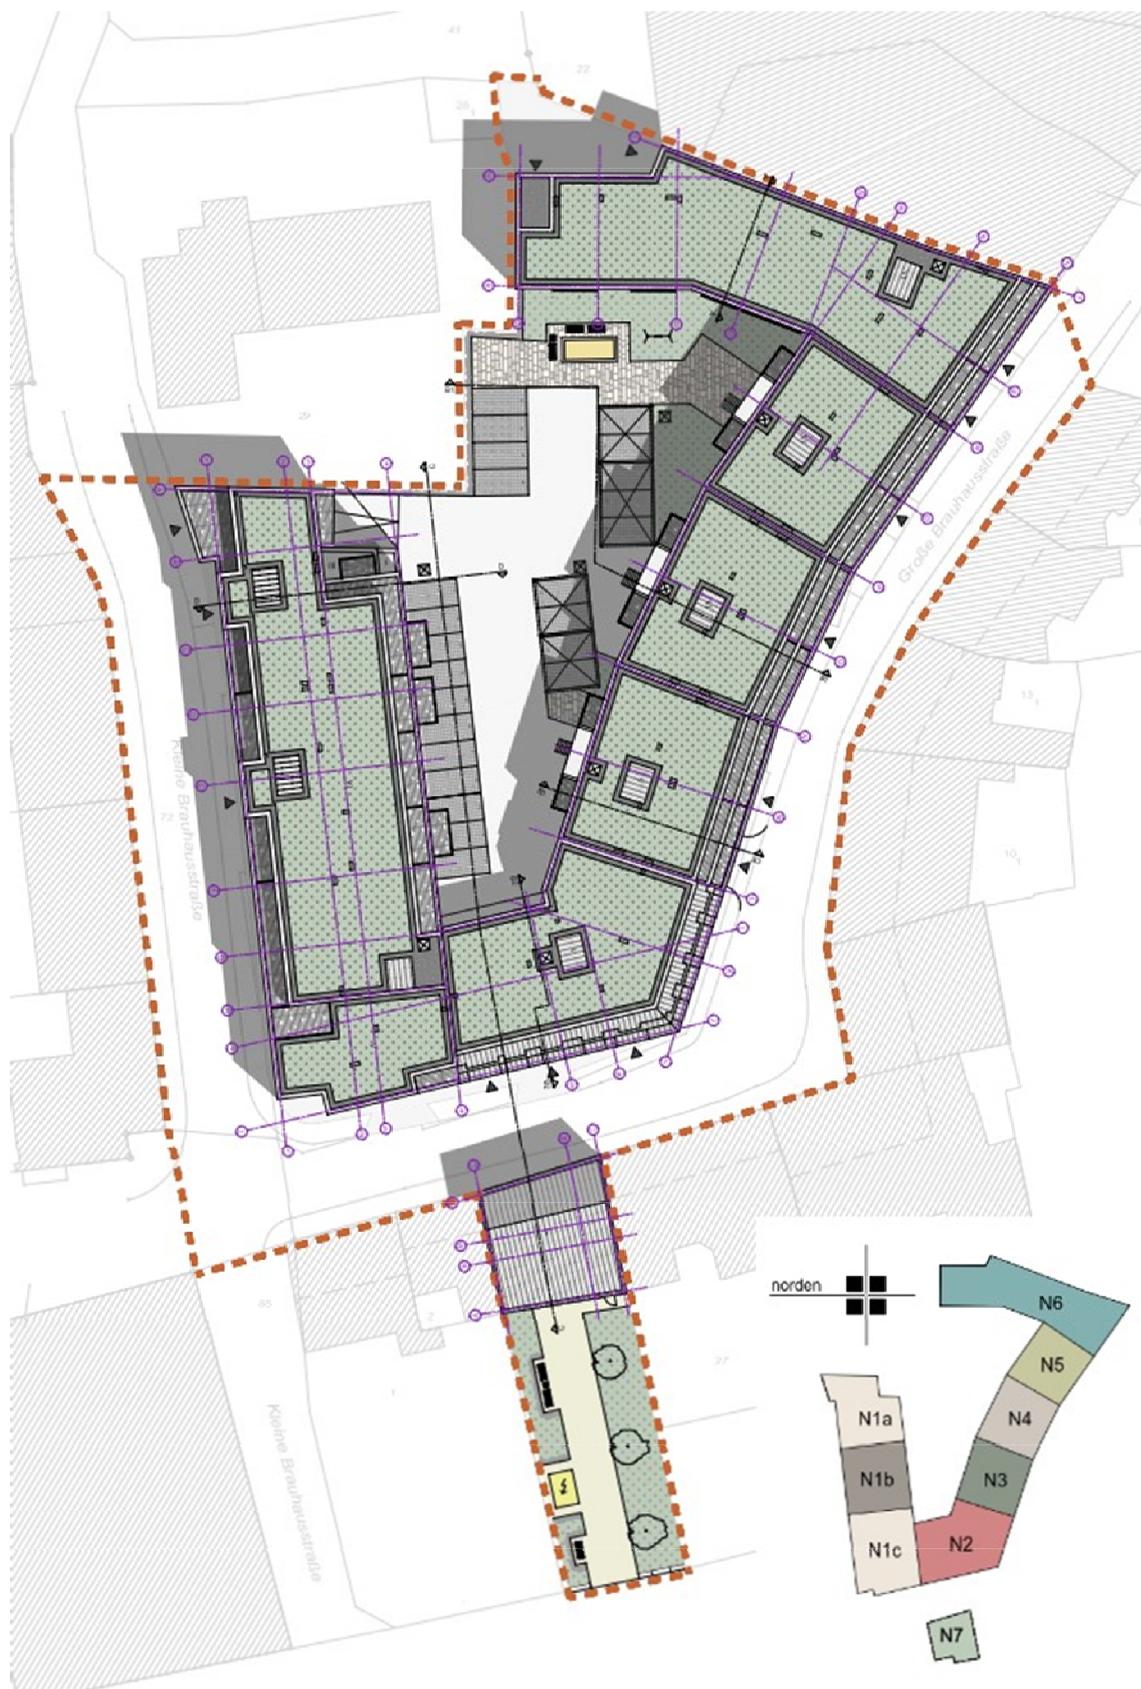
Dachaufsicht Vorhaben Brauhausstraße (Büro Homuth+Partner)
